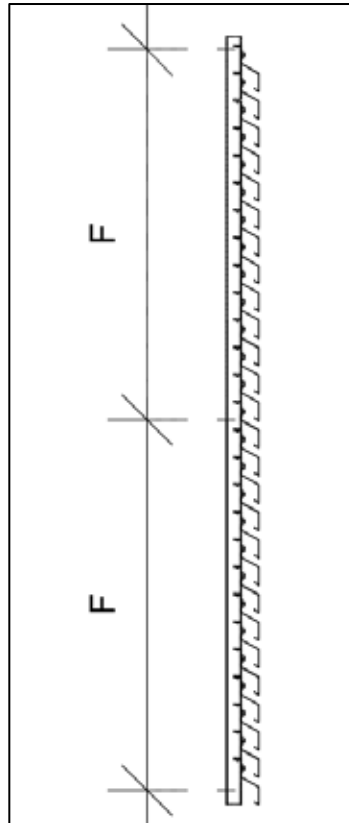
Coupe verticale du système de ventelles avec ossature secondaire type OMEGA.
